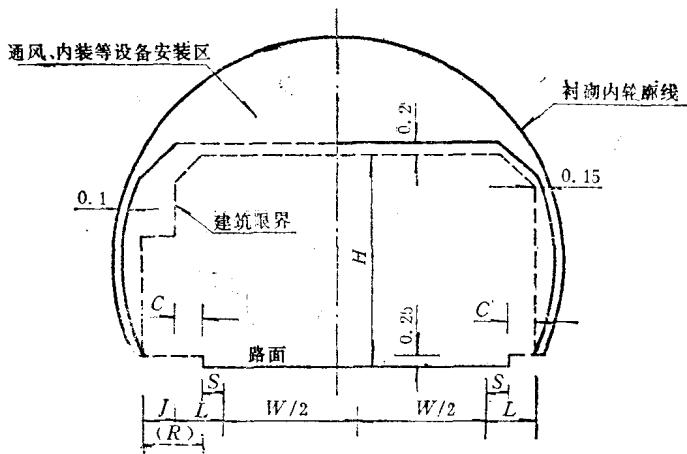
隧道横断面示意图 (尺寸单位: m)
